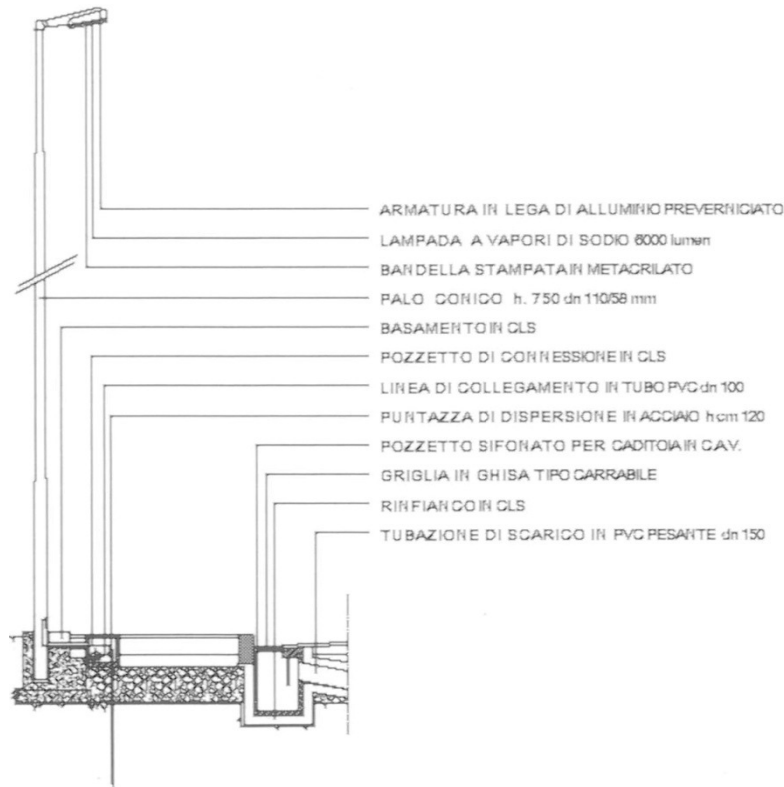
SEZIONE VERTICALE DELLA ZONA DELLA SEDE STRADALE OGGETTO DI INTERVENTO
